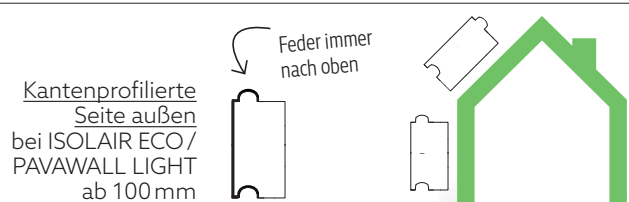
Profilierung ISOLAIR ECO / PAVAWALL LIGHT ab 100 mm
